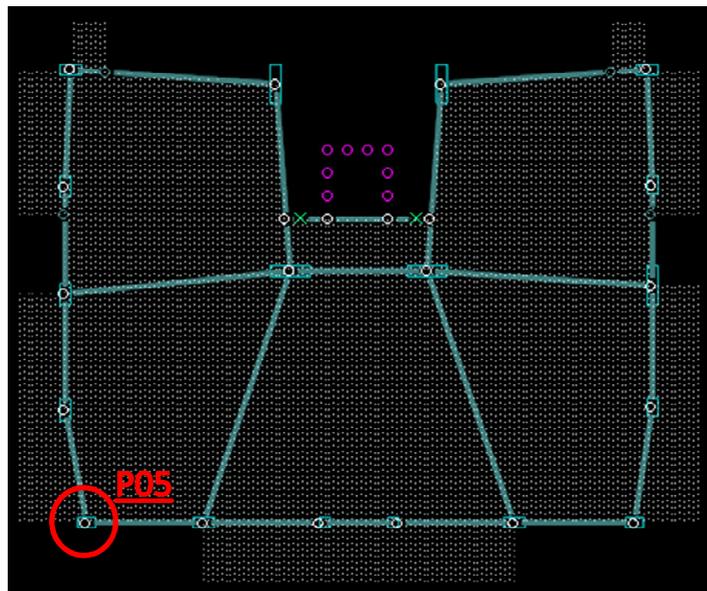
Vista in pianta del terzo impalcato, in cui viene identificato il pilastro P05.
